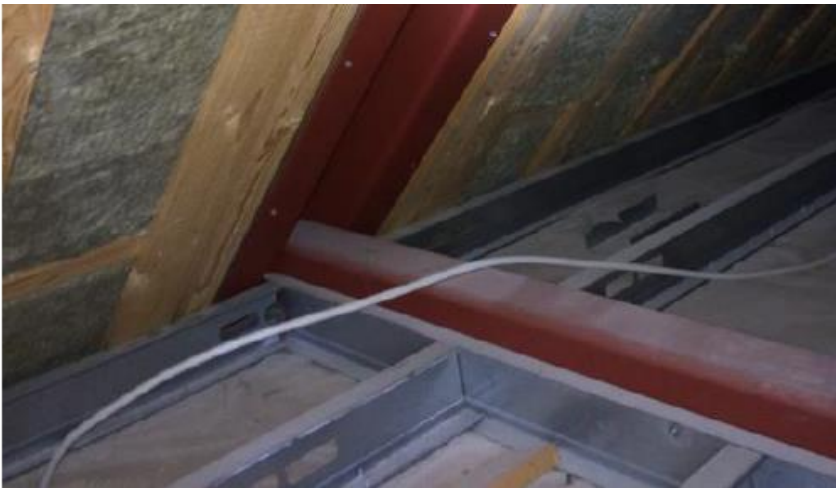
, eksisterende loftrum. Ståldragere og loft mod bolig er ikke isoleret.
